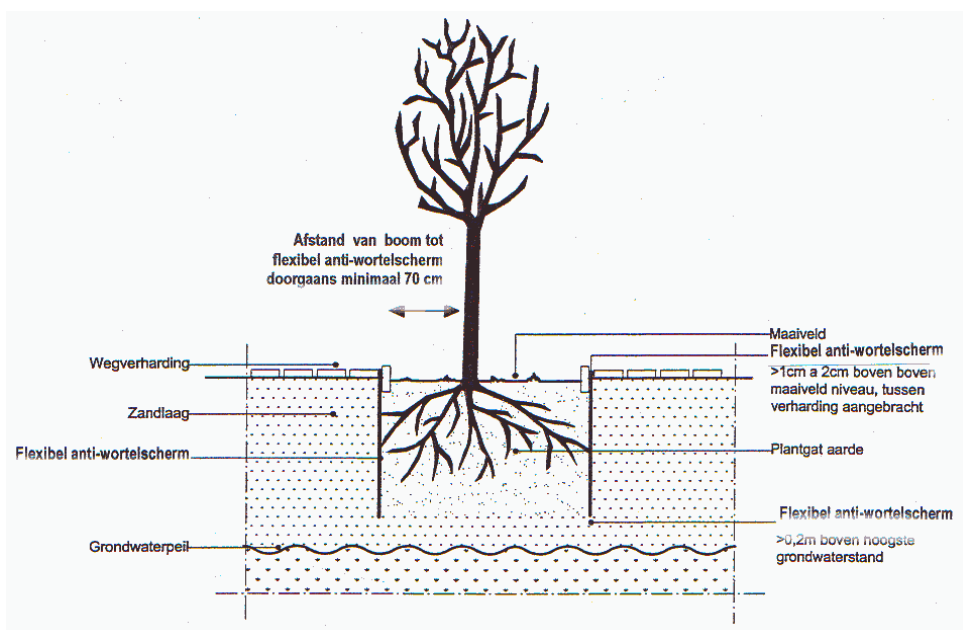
(detail 2b): gecontroleerde barriërvorming voor diepe wortelgroei
